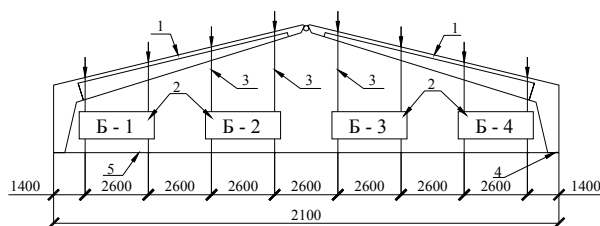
Схема стенда для испытаний рамных каркасов: 1 – рамный каркас; 2 – емкость (баки) для воды; 3 – подвески Ф25АIII; 4 – опорный башмак; 5 – металлическая стяжка
